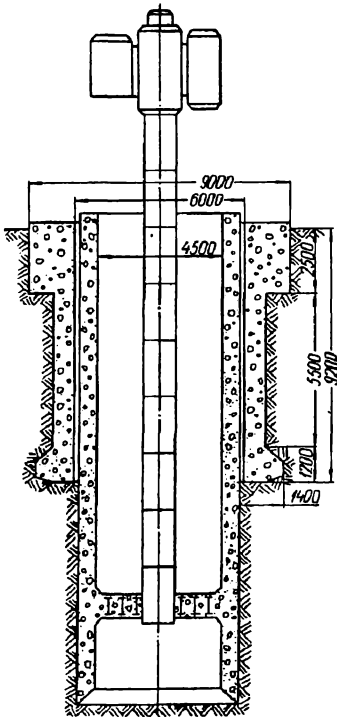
Конструкция устья для проходки ствола под сжатым воздухом с подвижной рабочей камерой
